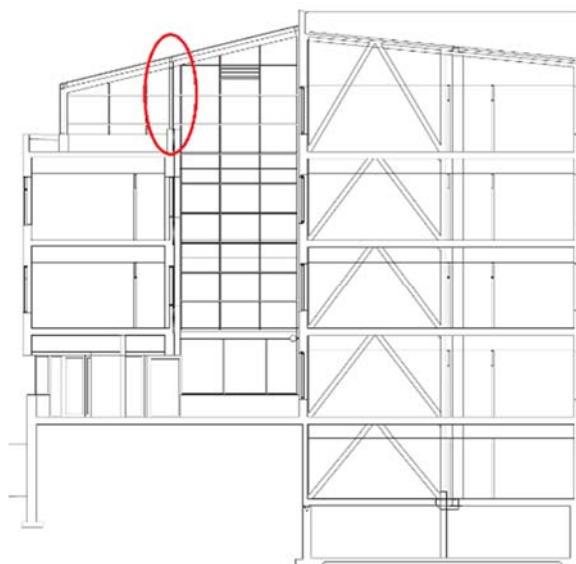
Plan 5 efter utflyttning av glasfasaden. Omarbetad med tillstånd.
